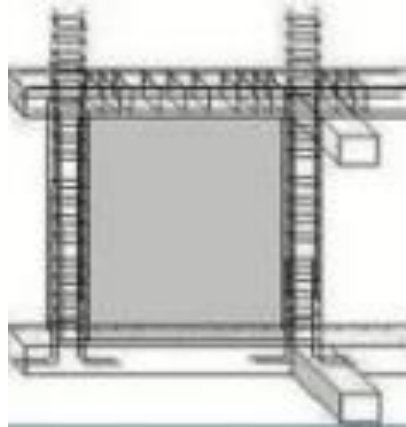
Mampostería de muros diafragma (QUIROGA, 2023)
